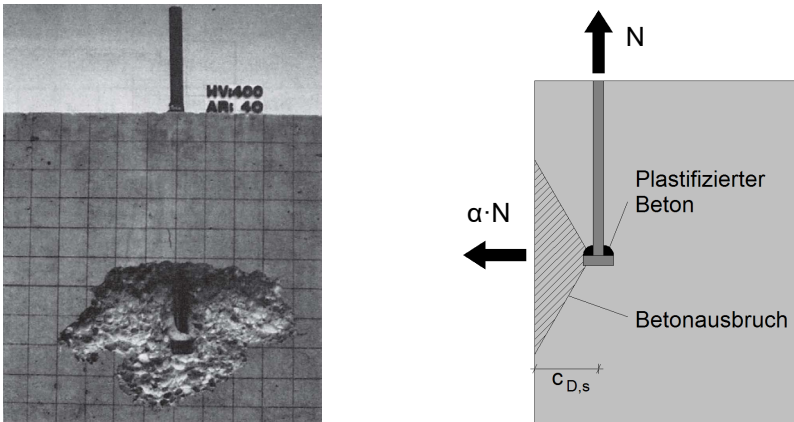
Seitlicher Betonausbruch eines randnahen Kopfbolzendübelns [Eligehausen 2000]
